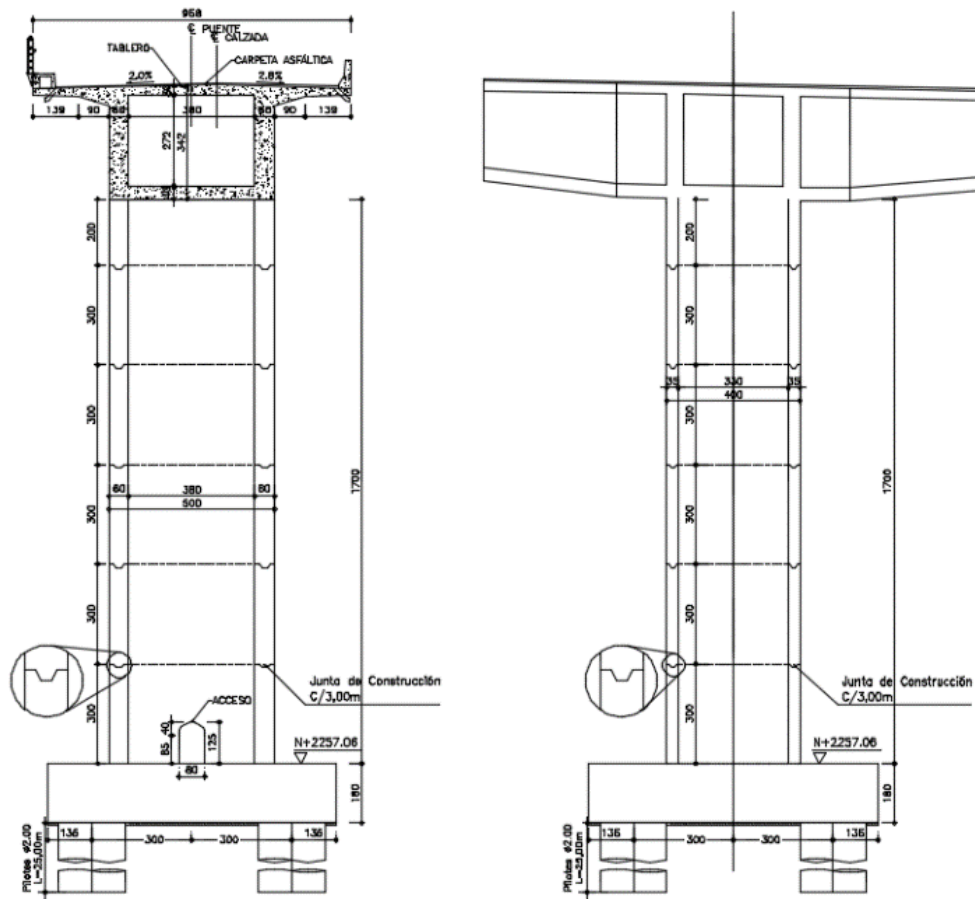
Geometría apoyo eje 4 – Puente Bermúdez
